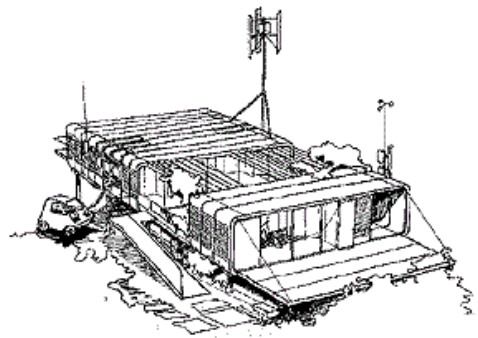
Marelles Projesi’nde kullanılan strüktür sistemi
